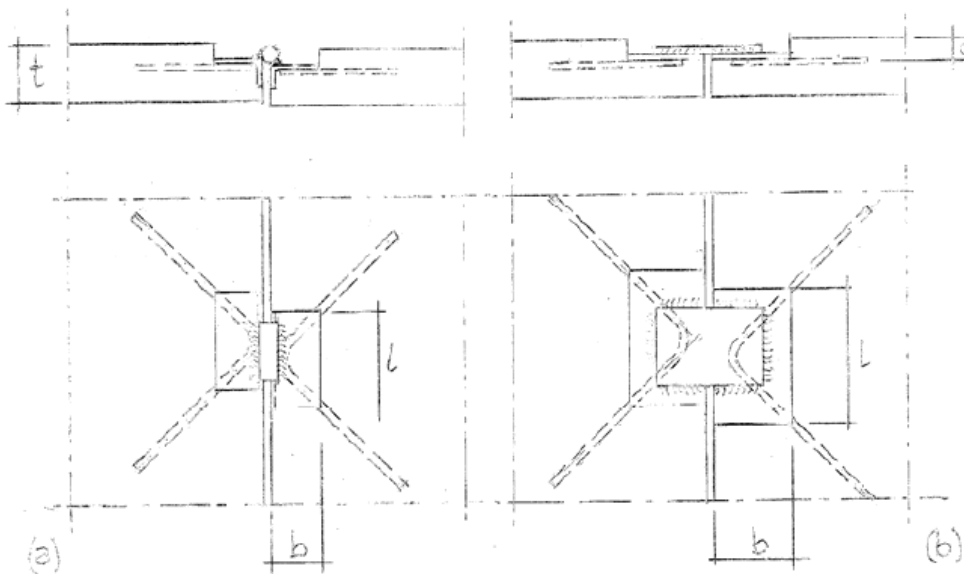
Conexión soldada unida mediante barra de refuerzo o platina de acero.
